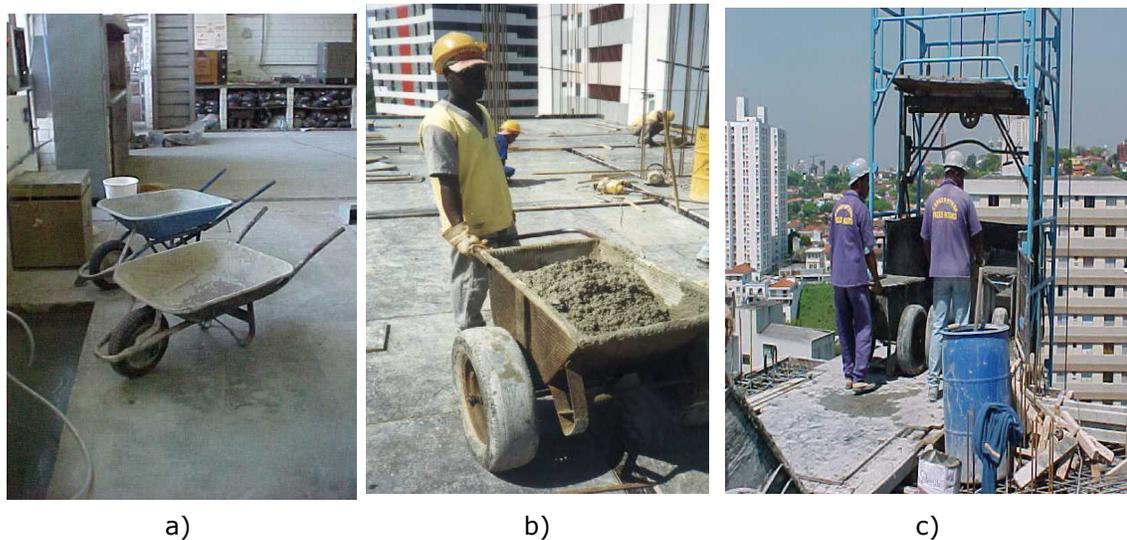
Equipamentos para transporte de concreto com decomposição do movimento: a) carrinhos-de-mão; b) jérica; c) elevador de carga.
